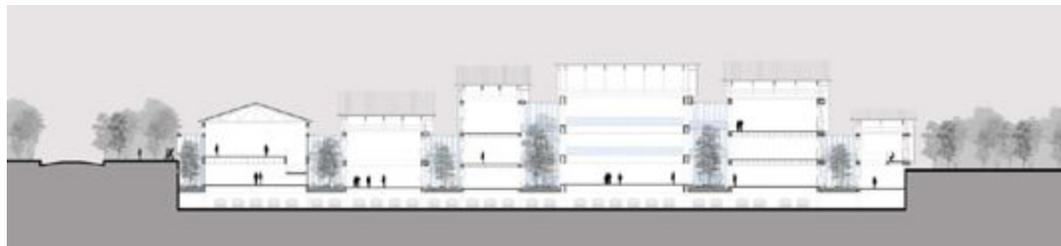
Corte transversal. Autoría: Elaboración propia
